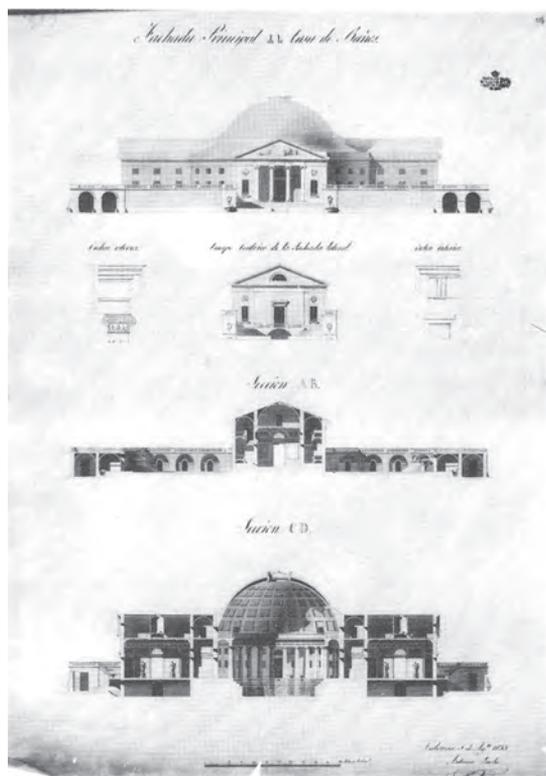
Fachada principal, cuerpo central de la fachada lateral, dos secciones transversales y detalles.
